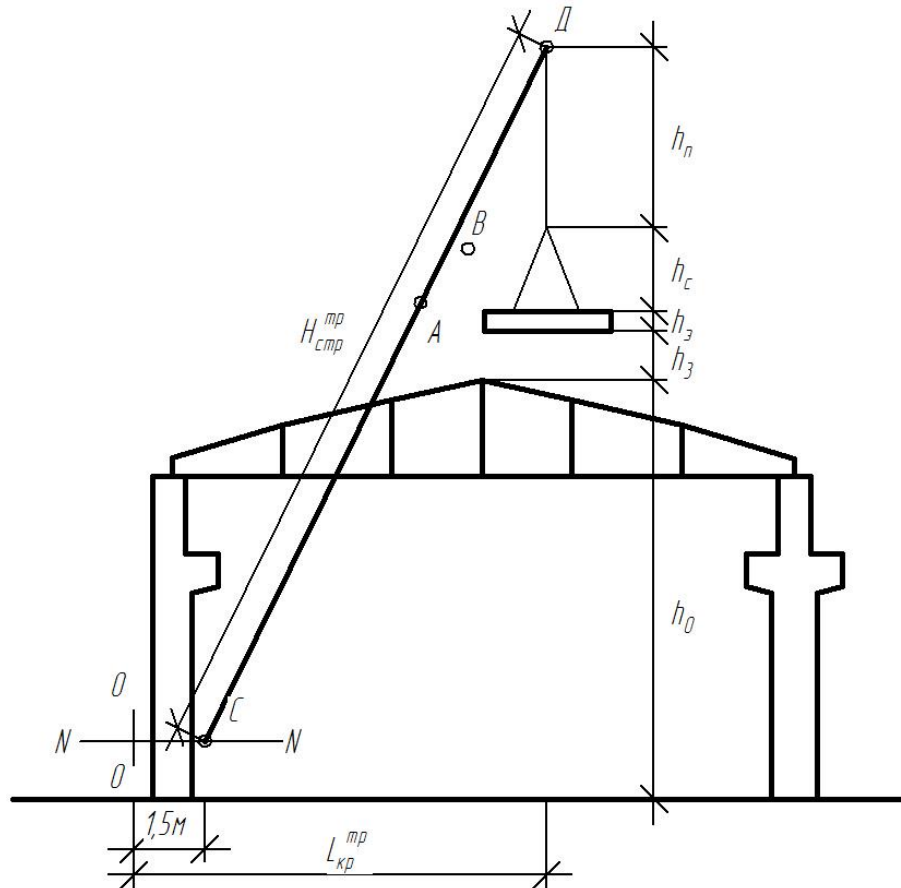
Схема определения параметров крана при поперечном методе монтажа плит покрытия
